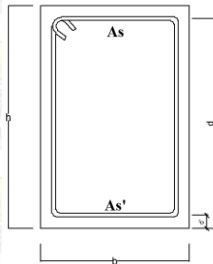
29 Potongan Detail Penulangan Balok Induk
